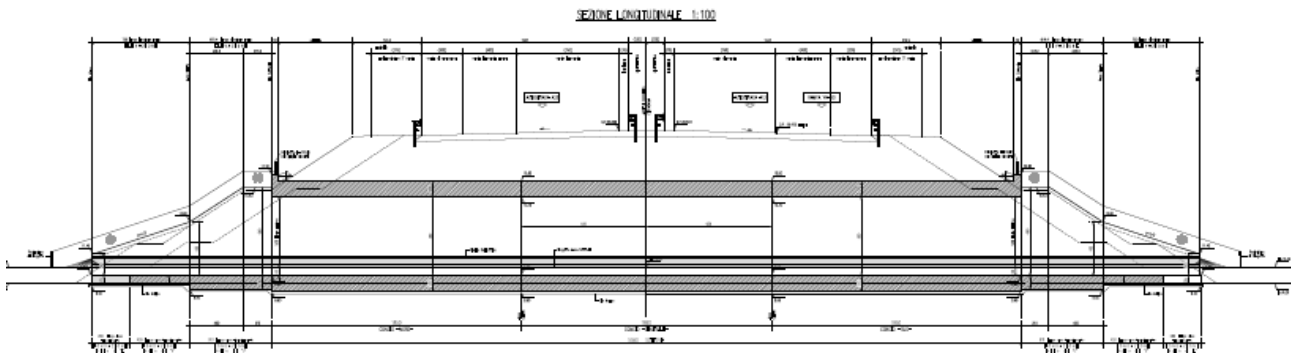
SEZIONE LONGITUDINALE SOTTOPASSO FUORI FALDA
